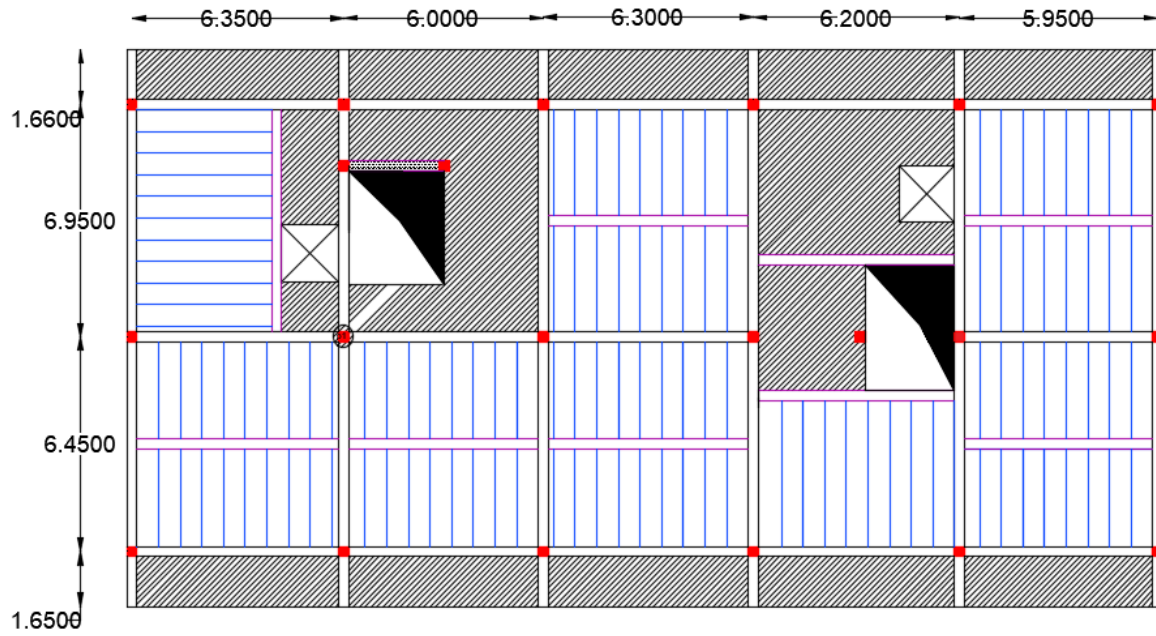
disposition des poutrelles des étage 1, 2, 3, 4, 5, 6, 7
